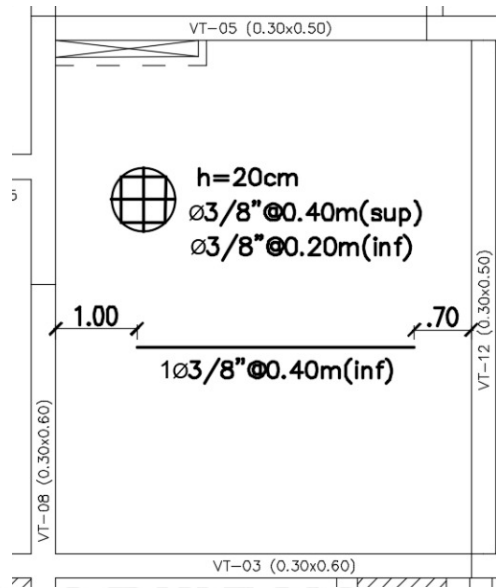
Disposición de acero en la losa maciza del ejemplo.
